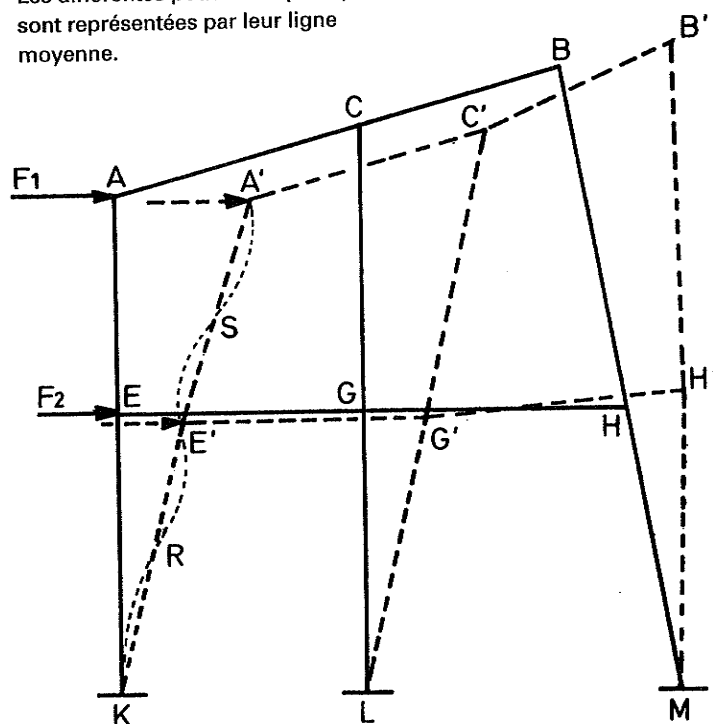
Portique en béton armé à nœuds rigides par les liaisons poteaux-poutres.
